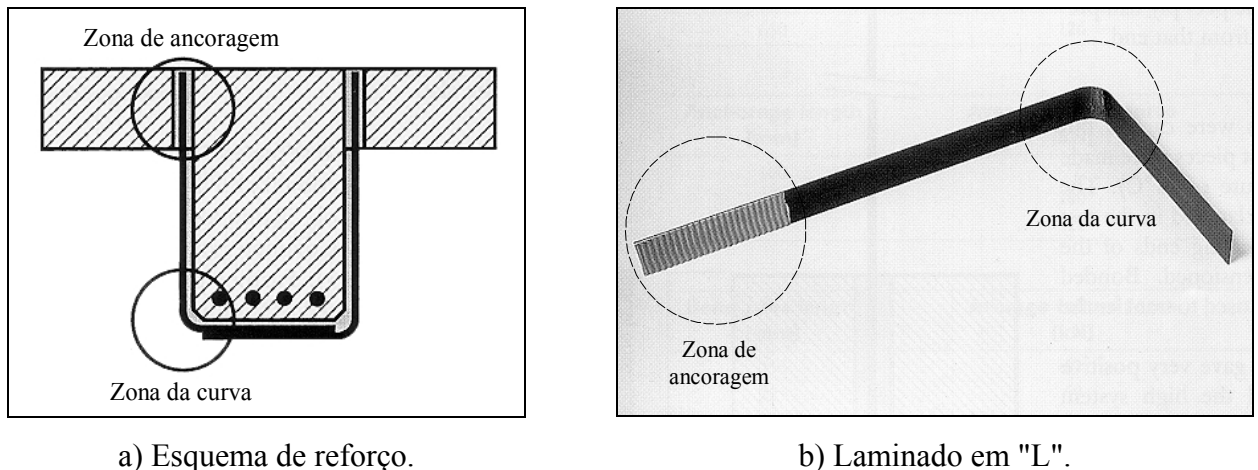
Adição de estribos planos de CFRP (Meier, 1998).
